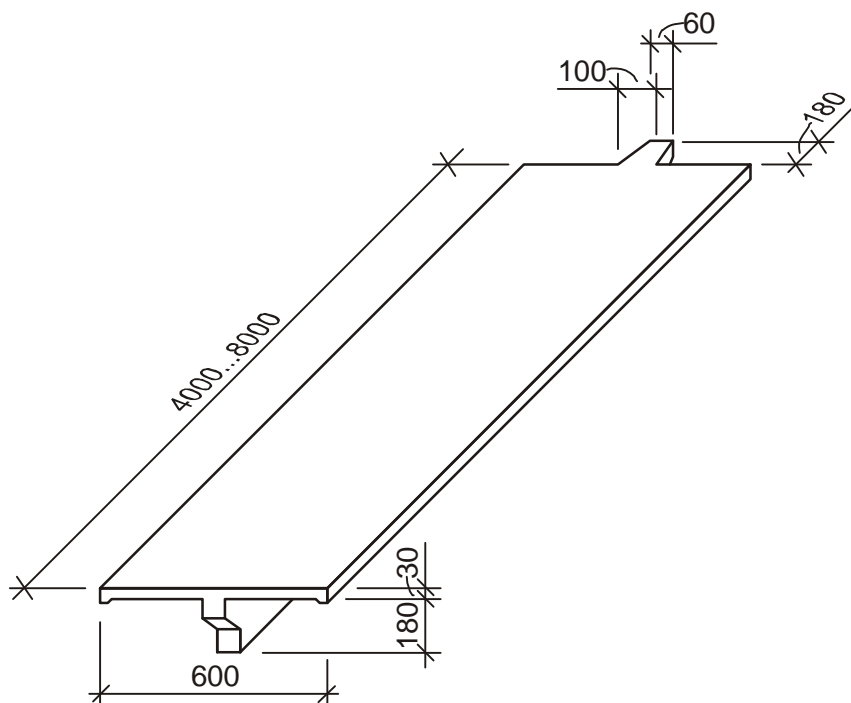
Сборная железобетонная крыша стропильной конструкции:
